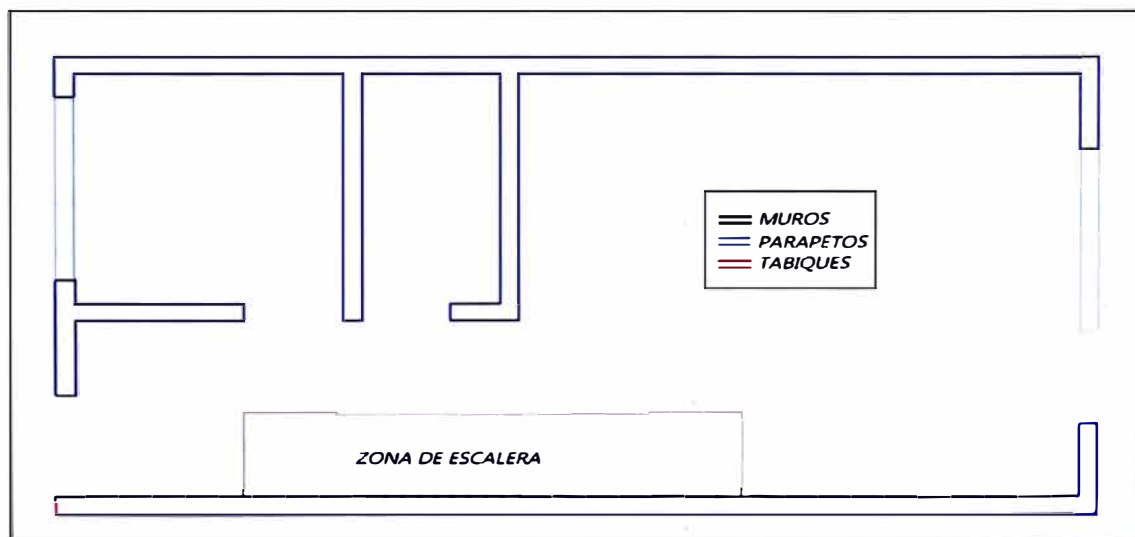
5 .- Distribución en planta de muros estructurales 1° piso.
